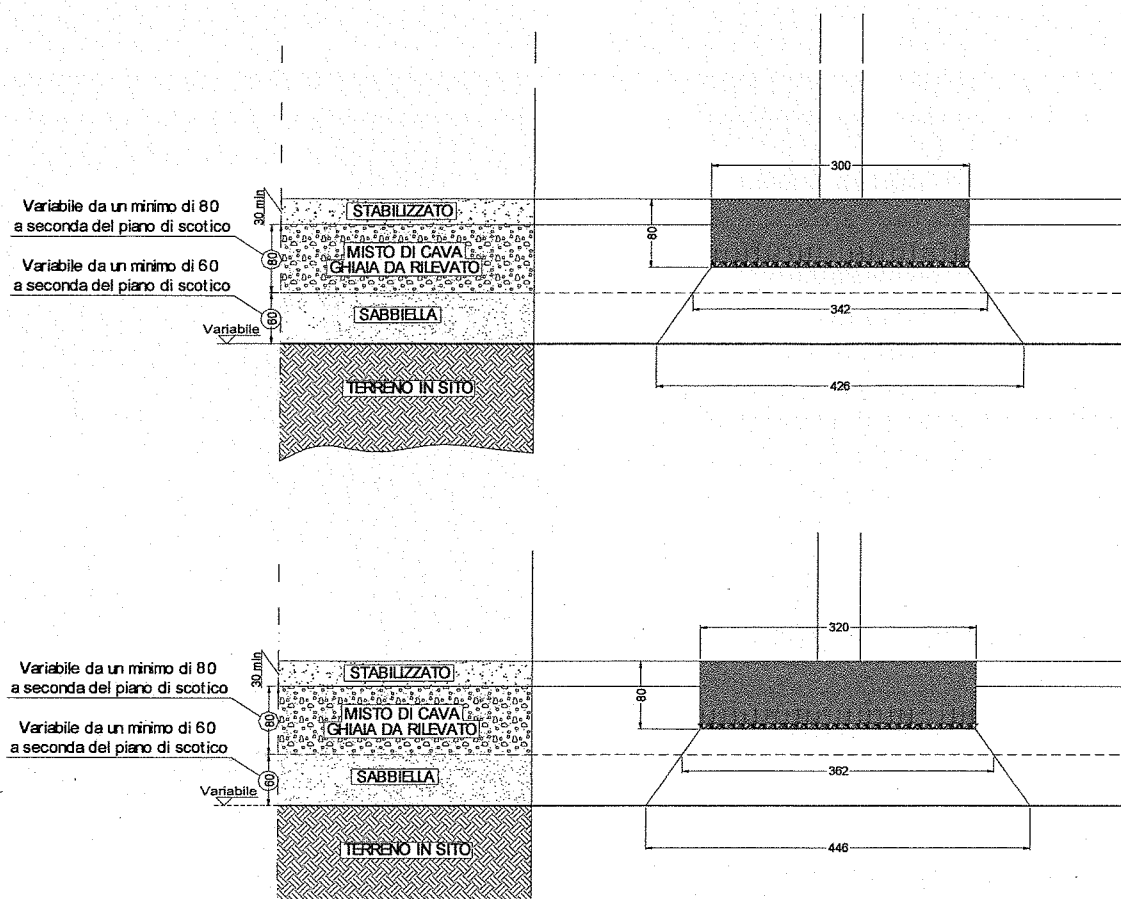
Ripartizione dei carichi sul pacchetto di fondazione
